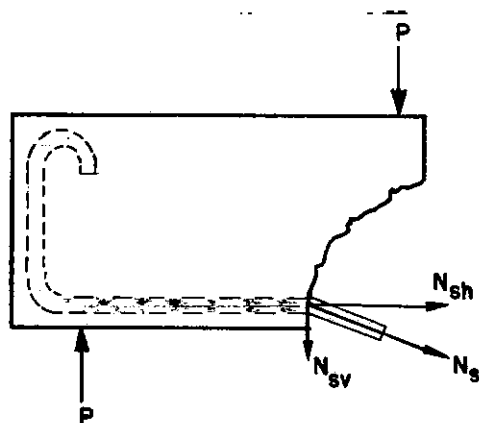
Forças na armadura de tração após o aparecimento da fissura de cisalhamento.
